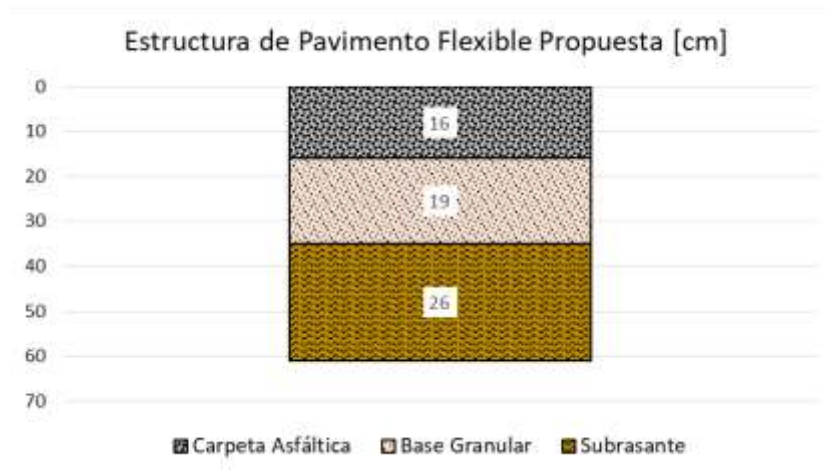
Estructura de Pavimento Flexible Propuesta
